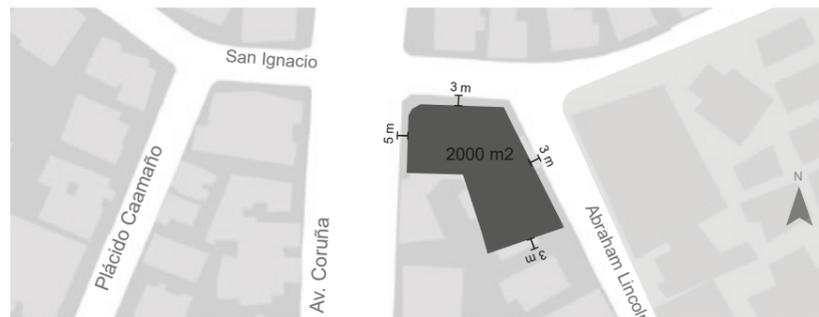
Dimensiones de retiros Equipamiento Propuesto. Adaptado de (POU , 2017,p.129).
